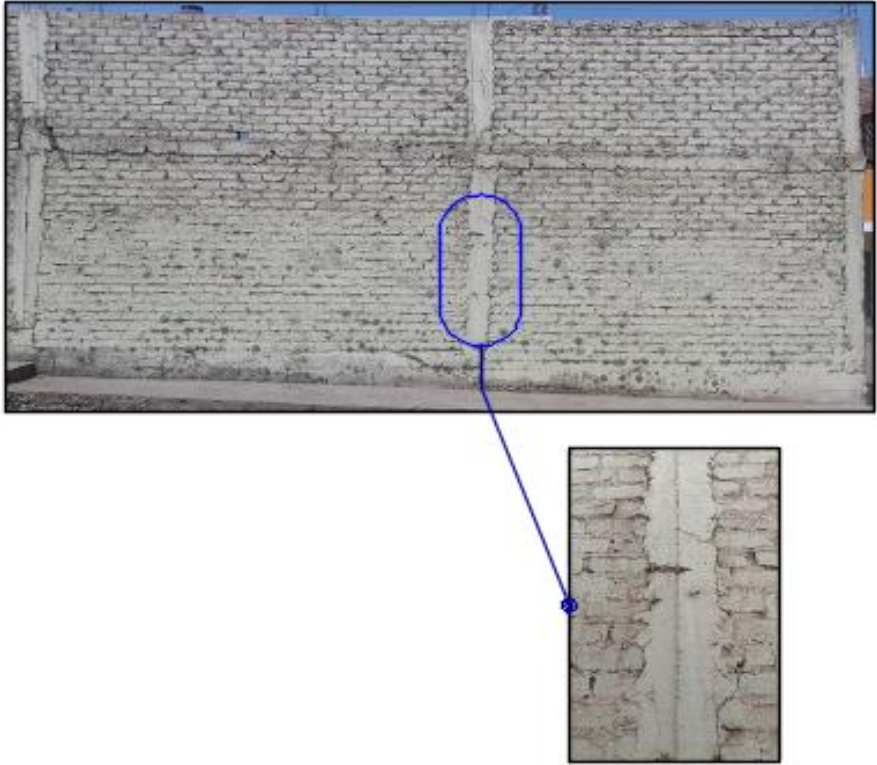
Presencia de grietas en la albañilería en la UM-7.
